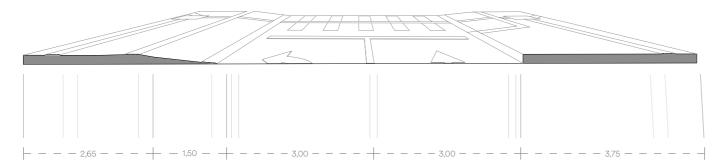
Sección B-B: Propuesta para la calle Padre Julio Matovelle.
